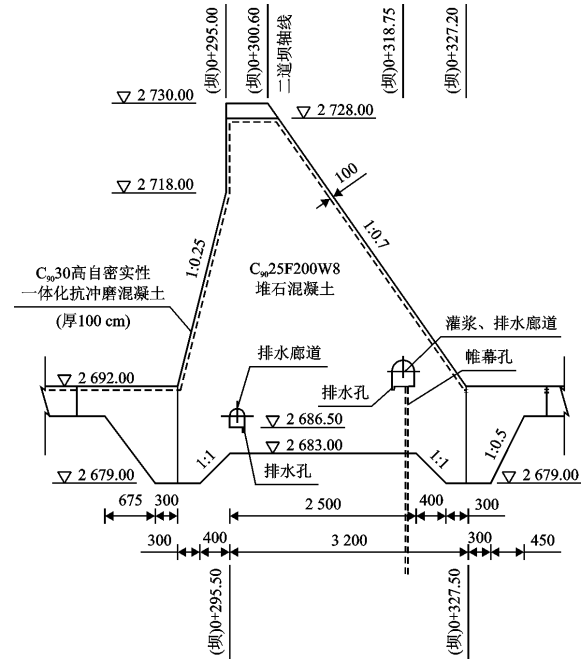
叶巴滩堆石混凝土二道坝结构布置图(单位:cm)
